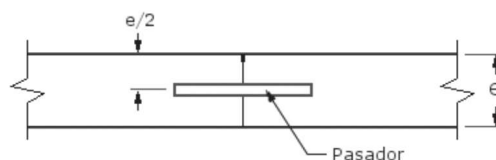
JUNTA TIPO B. JUNTA TRANSVERSAL DE CONSTRUCCIÓN.
